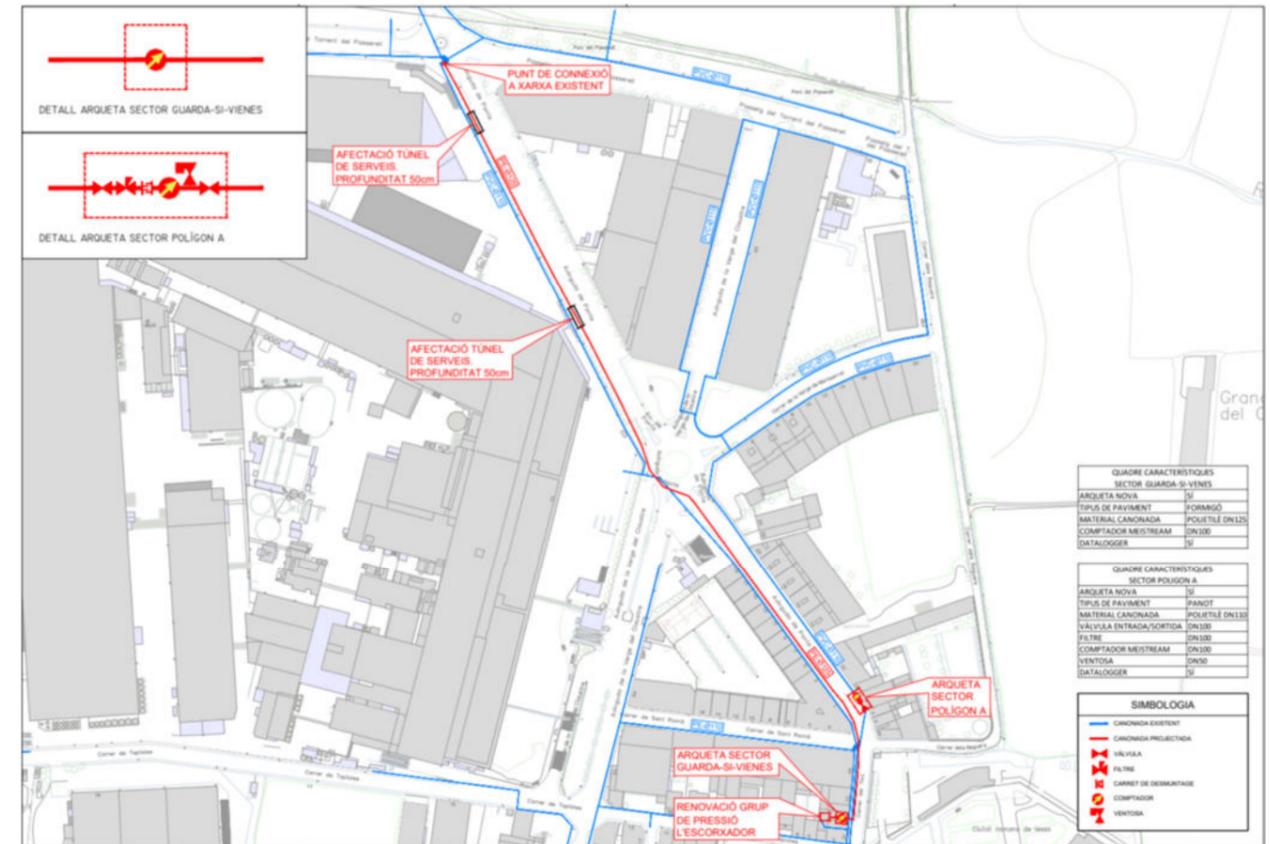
Planta general del traçat de les noves canonades a Guarda-si-venes
